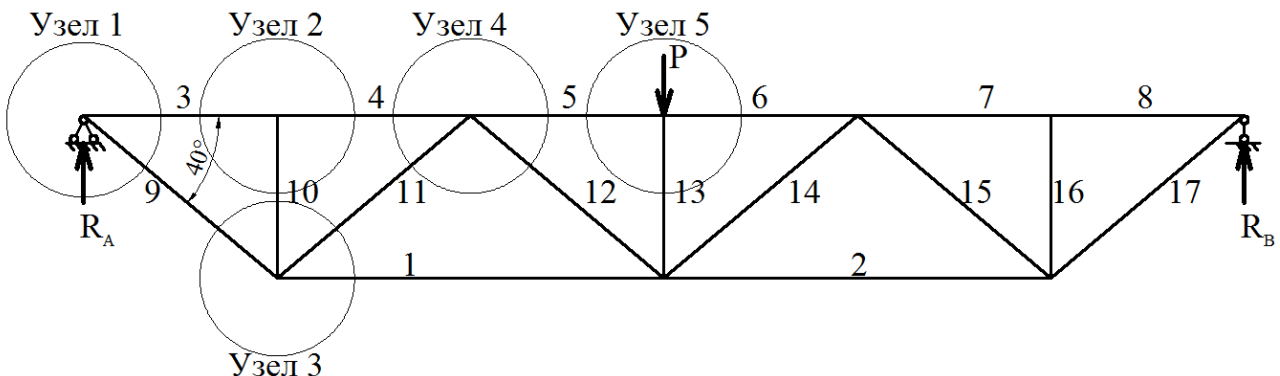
Схема к расчету усилий в элементах фермы методом сечений
